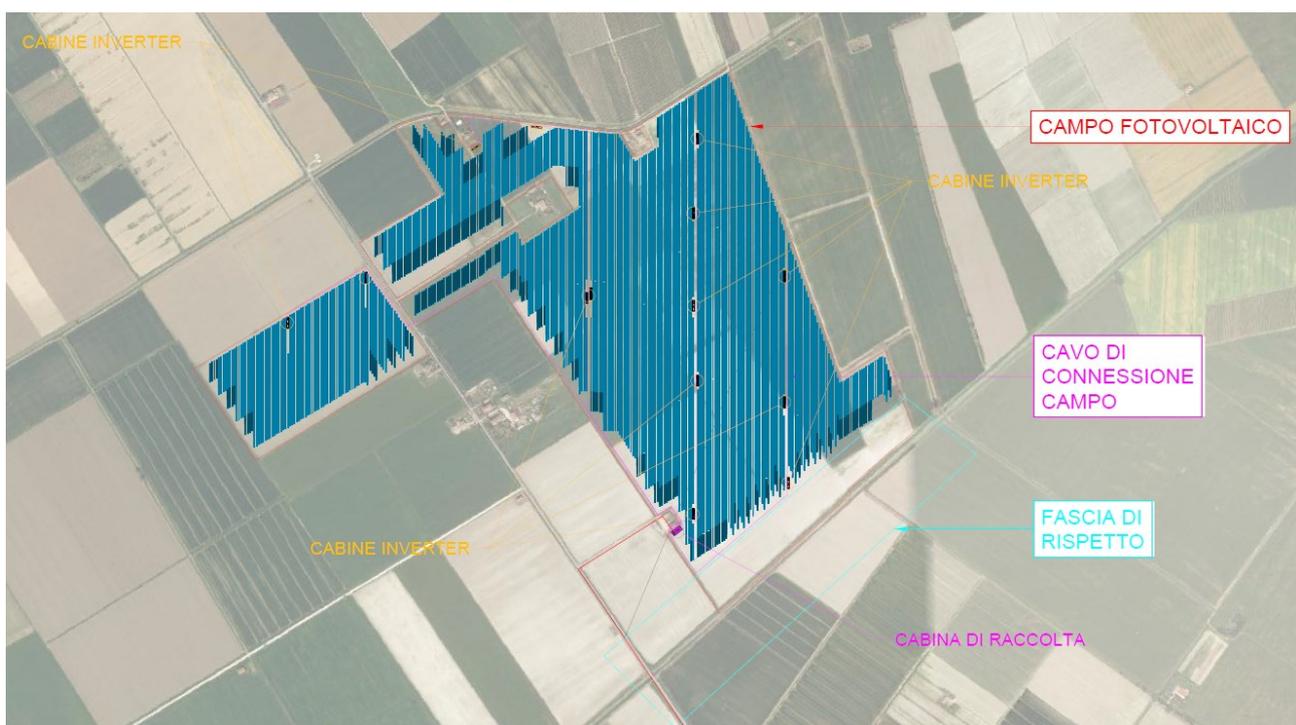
stralcio dell'elaborato TAV 2.1_FOTOV_Layout su Ortofoto
